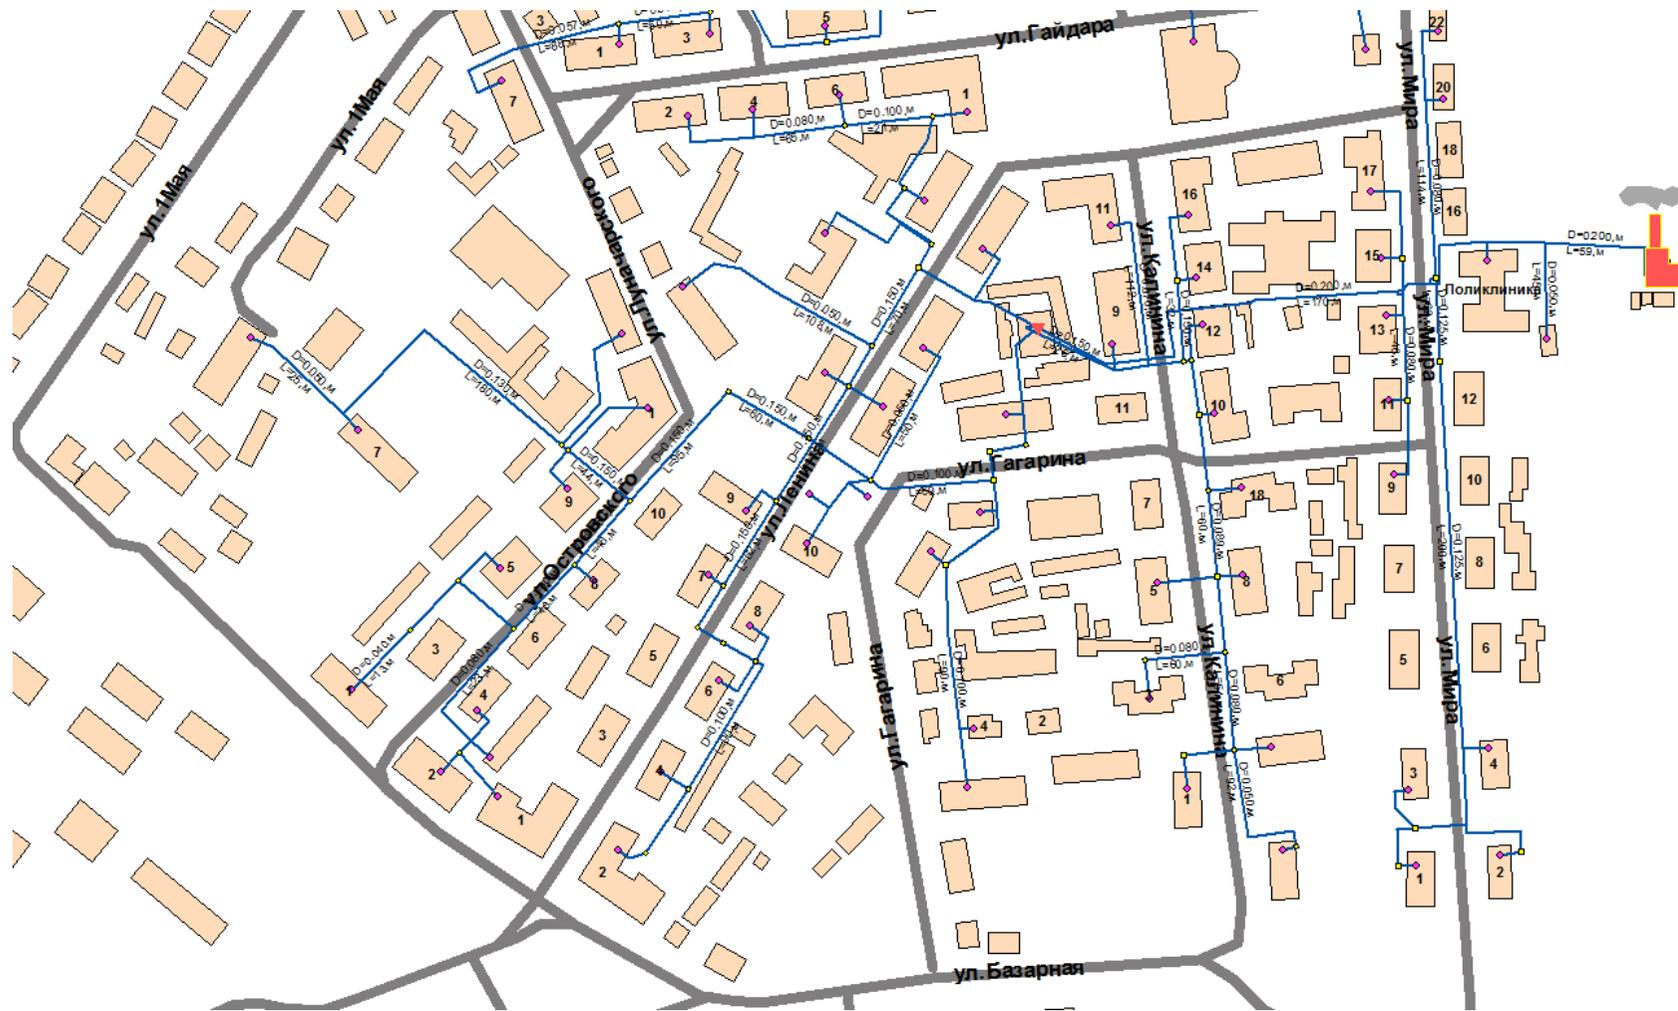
Схема тепловой сети от котельной по ул. Мира д.14а
